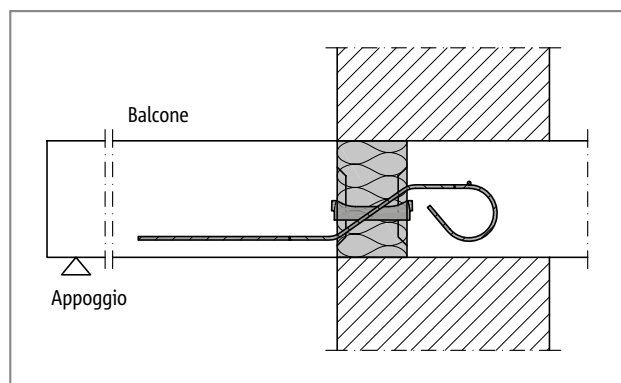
Schöck Isokorb® tipo QXT: raccordo con appoggio su muratura termoisolante monostrato (tipo da QXT10 a QXT40)
